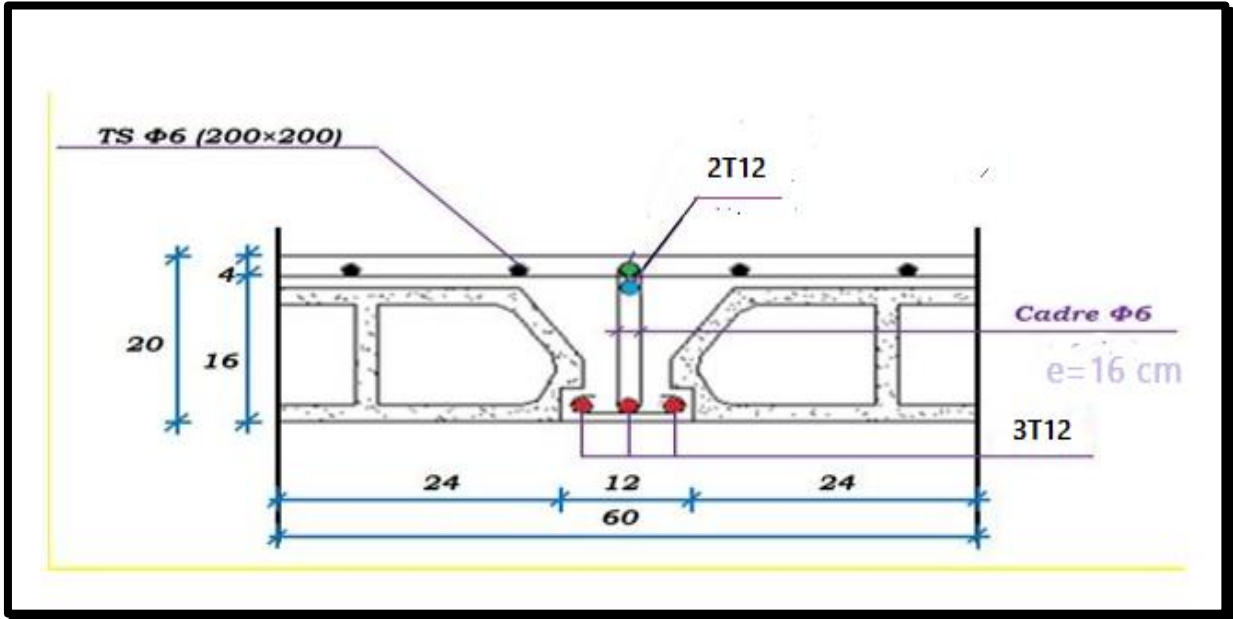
Coupe transversale d'un plancher à corps creux
